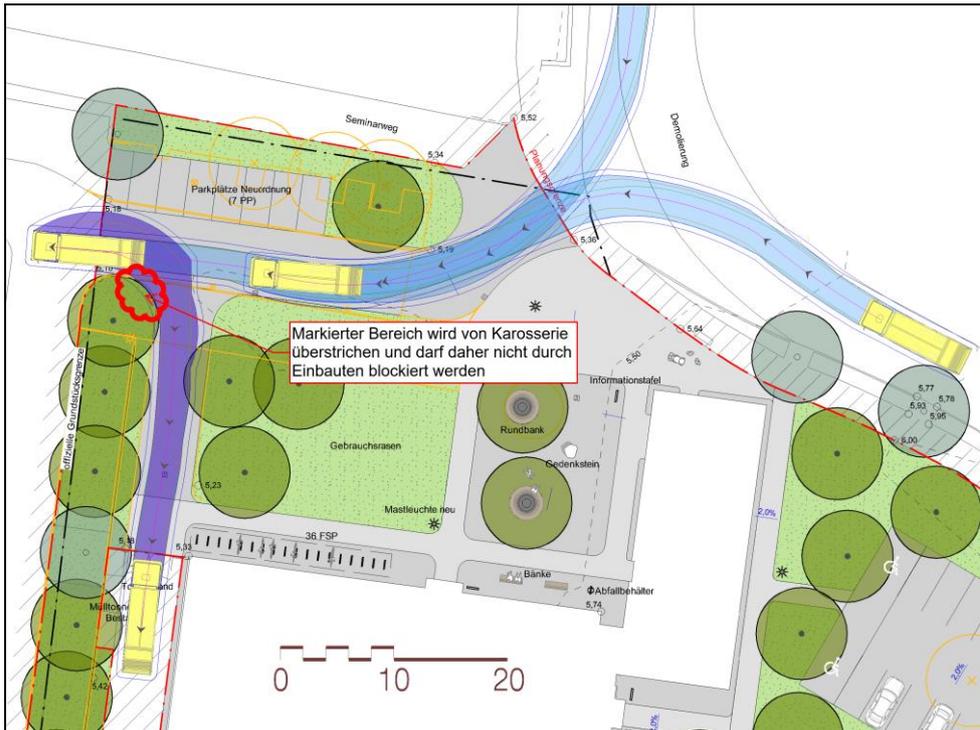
Einfahrt Abfallentsorgung – Parkierungsanlage West
